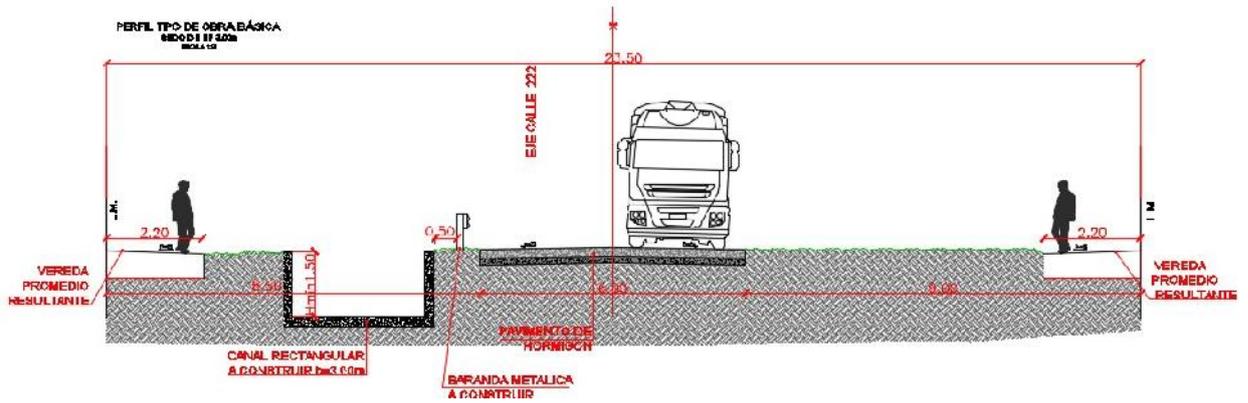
Perfil Tipo de Obra Básica. Canal Rectangular Abierto. Ancho = 3.00m
